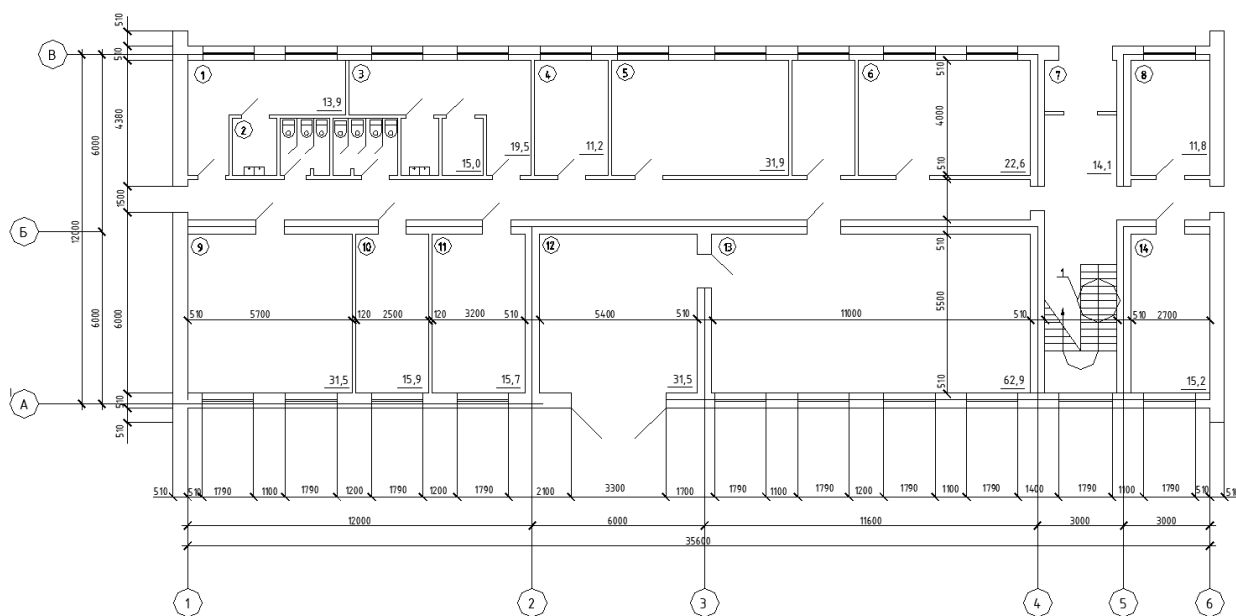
План-Схема будівлі на відм. 0,00 м
